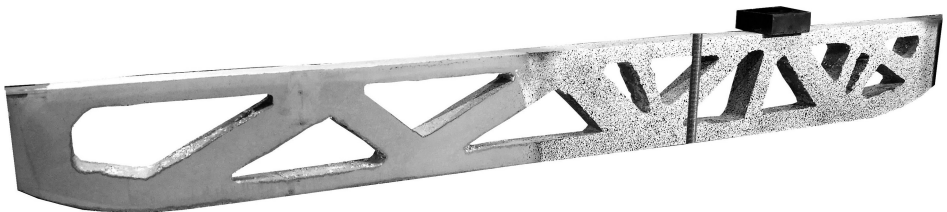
Gegossener topologieoptimierter Betonträger (Beton: Gießbeton C25/30, Bewehrung: CFK-Lamelle)
